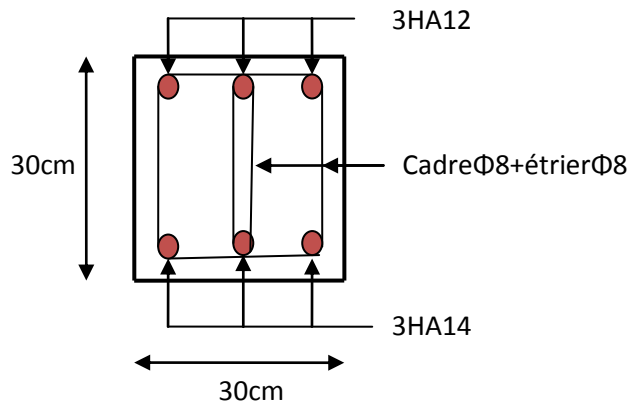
Schéma de ferrailage de la poutre palière de l'escalier des étages courants.
